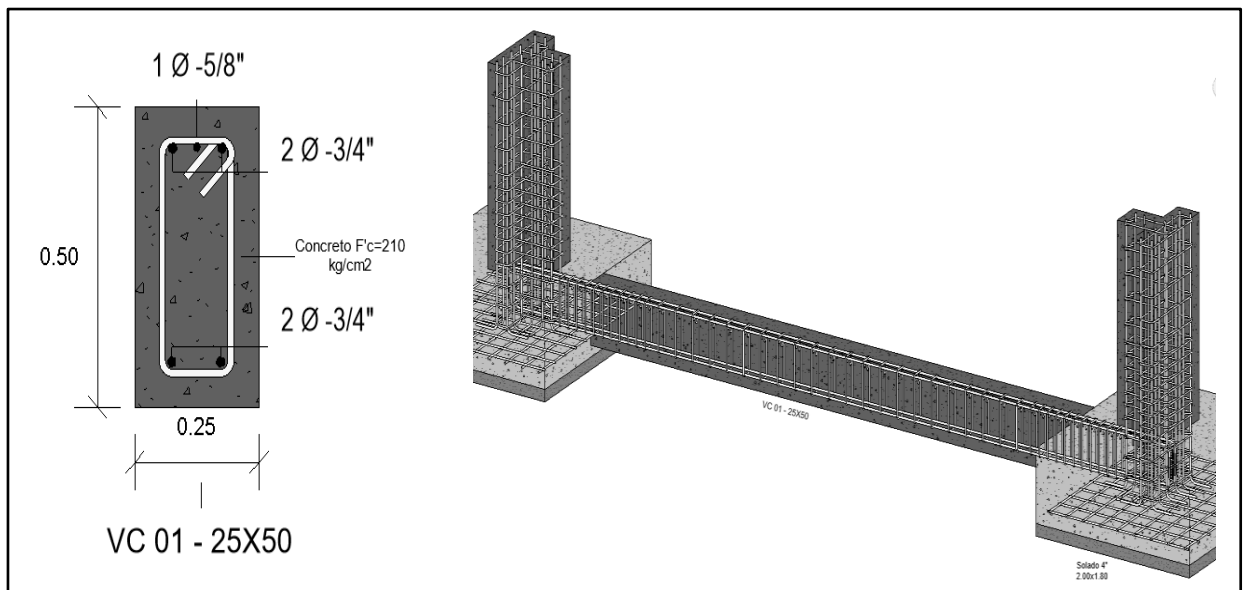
Acero de refuerzo en vigas de cimentación VC 1-25x50
